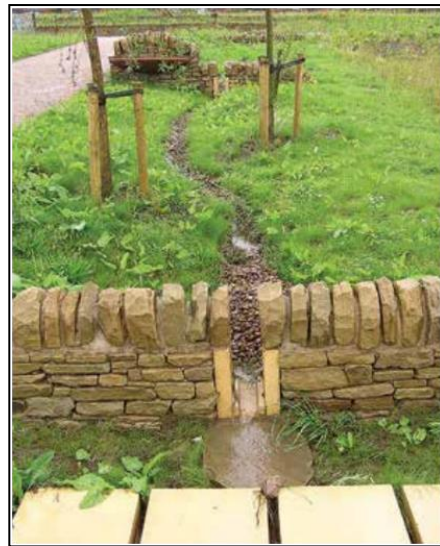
Elemento tipo presa de madera para cunetas verdes.
